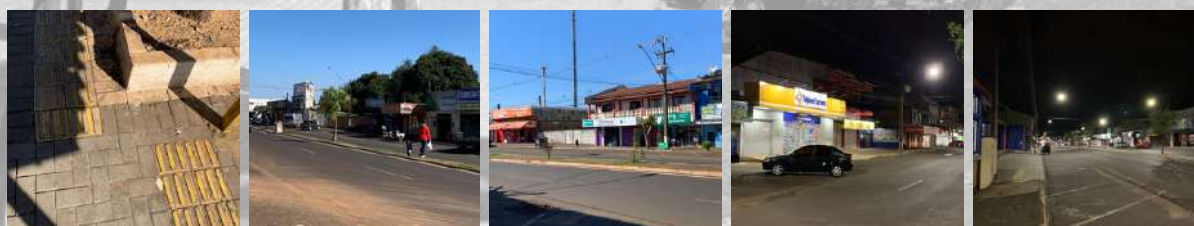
Situações encontradas no trecho: alguns segmentos com falhas de conexão do piso tátil, travessias improvisadas, uso misto das edificações, comércios noturnos e iluminação do trecho.
